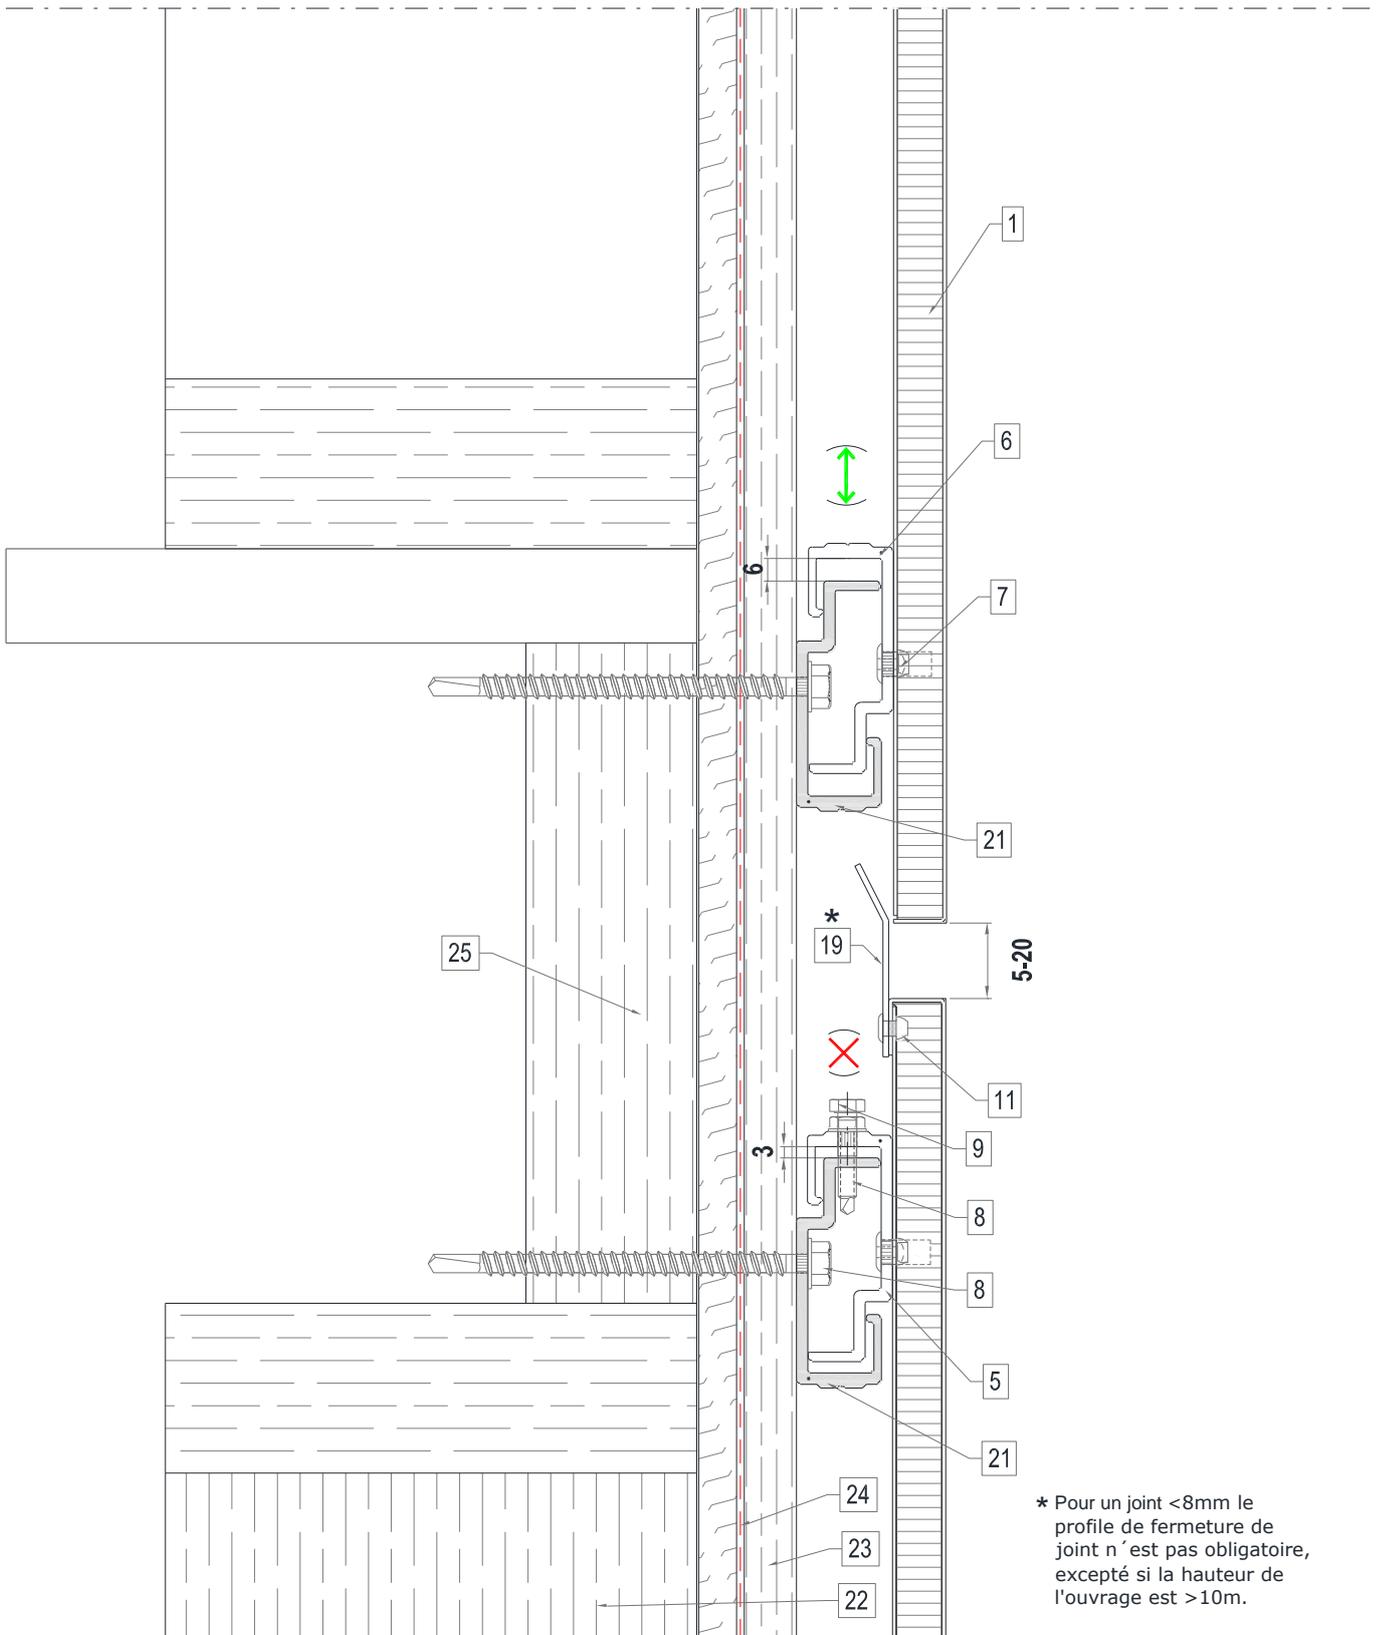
Recouvrement du pare-pluie – Coupe verticale sur COB
